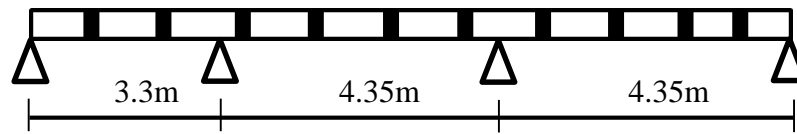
Schéma statique de poutrelle Type2 (3 travées)
